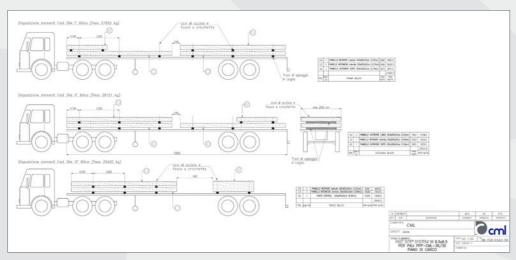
Piano di carico FAST SITE® SYSTEM 36
